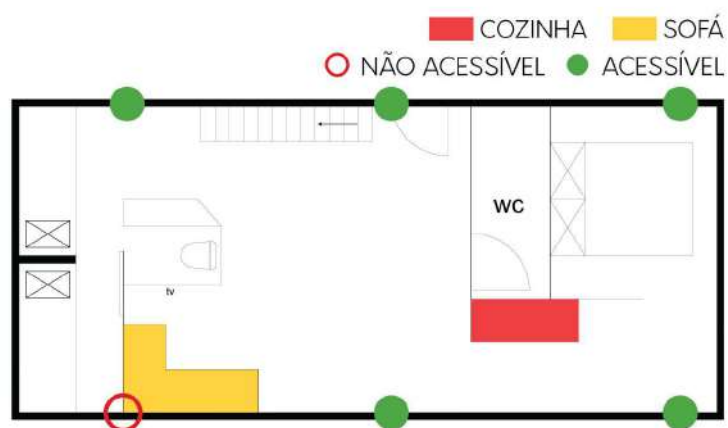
Atualização dos pontos de amarração tendo em conta as alterações feitas à planta.
